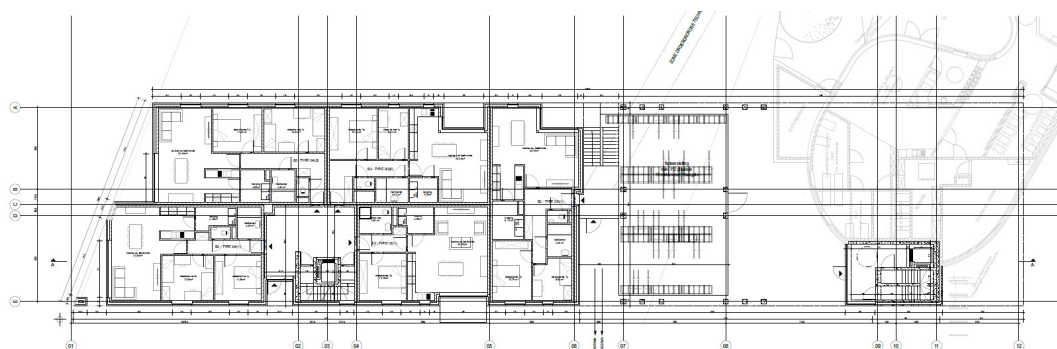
Blok 1 – detail ondergrondse ruimte.
